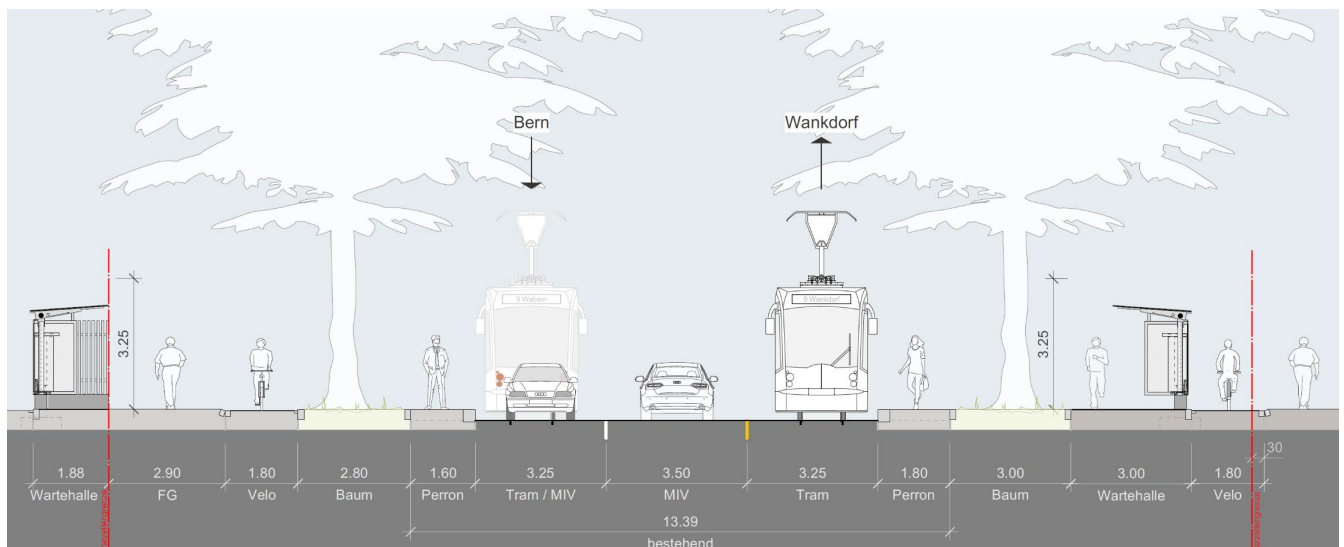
Querschnitt Haltestelle Papiermühlestrasse, Blickrichtung Wankdorfplatz
